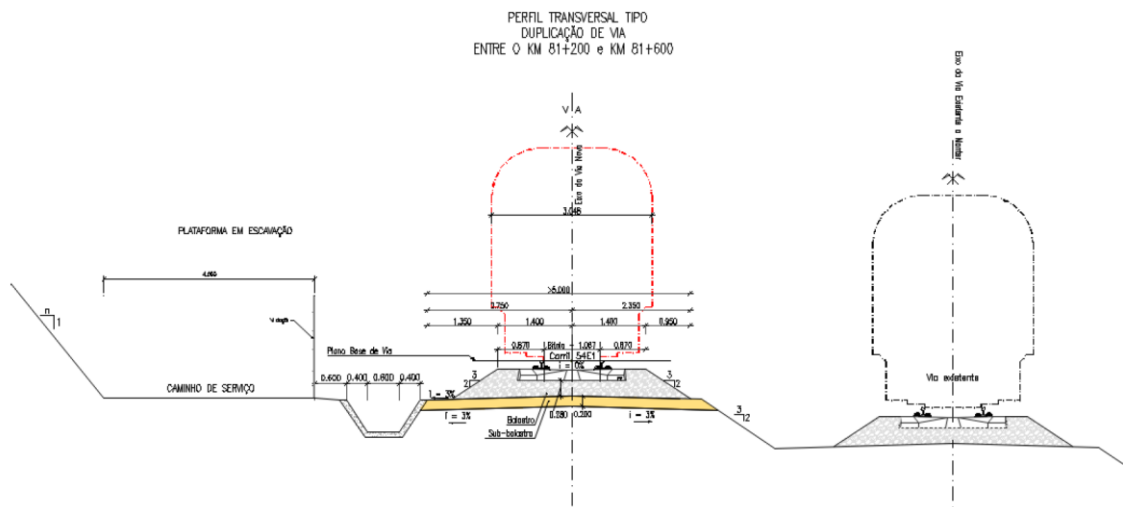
Secção transversal tipo da via única entre o k81+200-81+600
